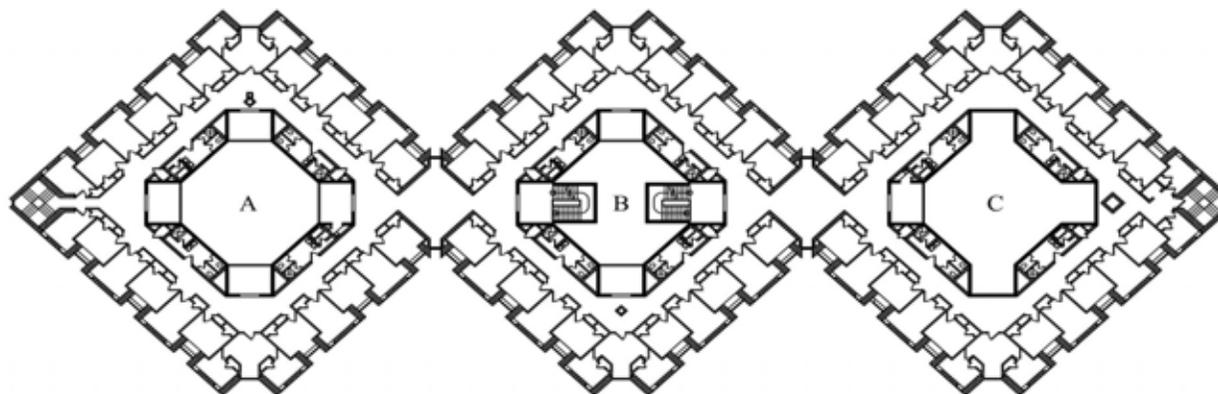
Erdmand Hall - Planta arquitectónica tipo.
